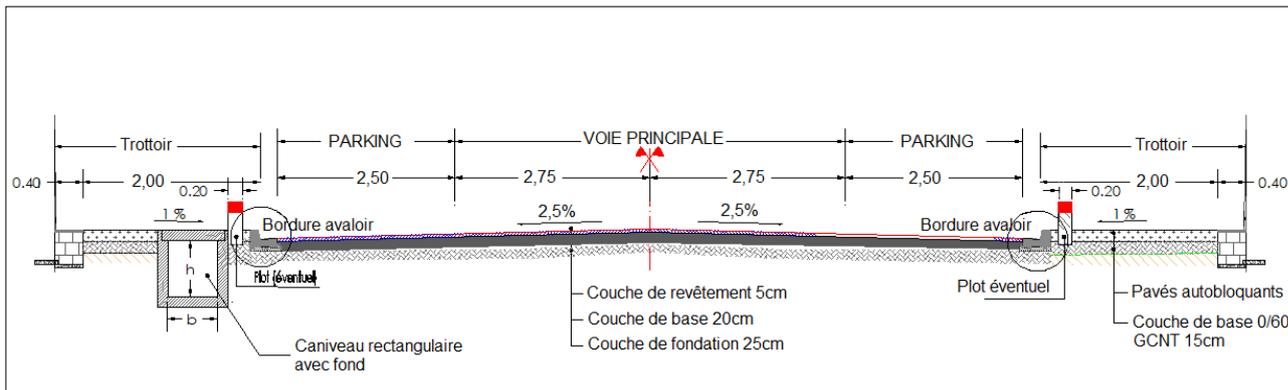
CHAUSSEE AVEC 2 VOIES DE PARKING
